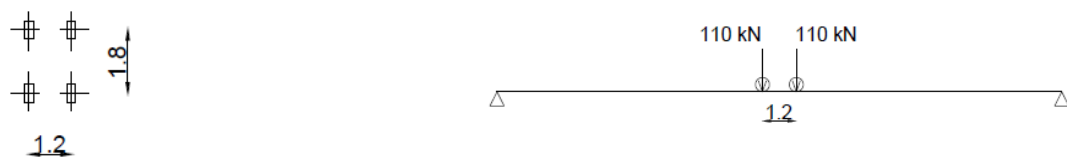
Geometria e intensidade das cargas Tandem previstas na norma AASHTO, em planta (esquerda) e em perfil longitudinal (direita).
